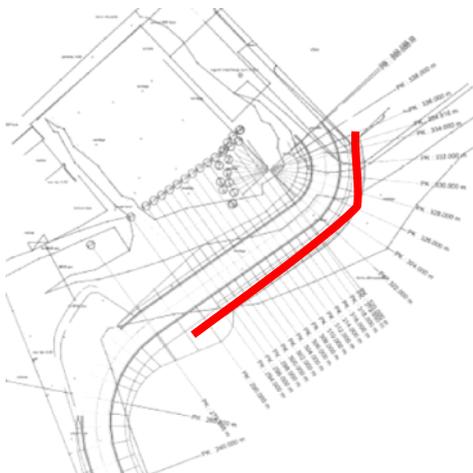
Vue en plan (Valerian): situation du mur en rouge
